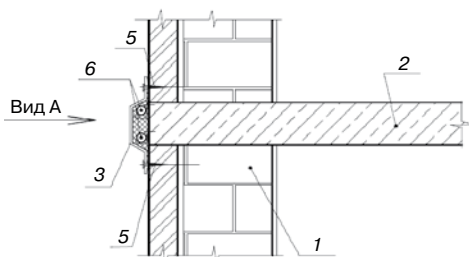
Устройство для утепления наружной стены здания трапециевидальной формы
